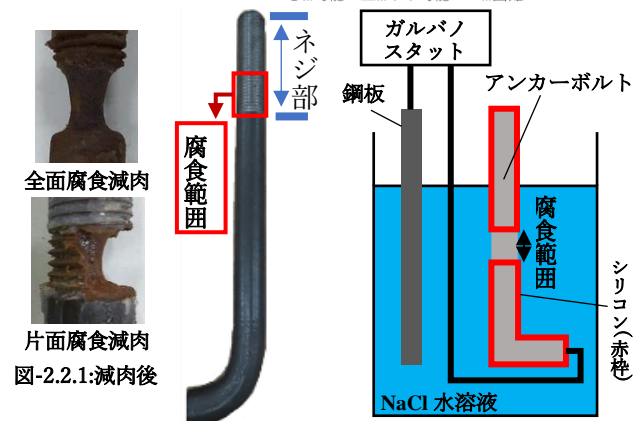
減肉後 図-2.2.2 アンカーボルト 図-2.2.3 定電流電解試験図
